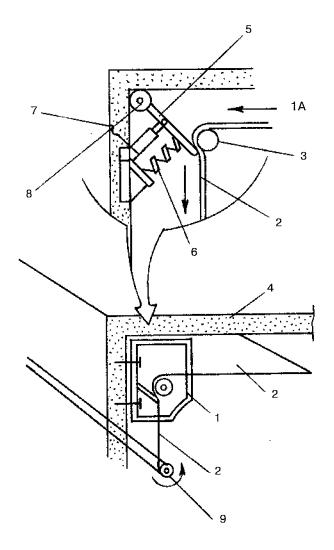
Закрепление багетов для натяжного потолка: 1 — корпус рейки крепления; 2 — пластиковая пленка; 3 — валик; 4 — потолочное перекрытие; 5 — рычаг; 6 — пружина рычага; 7 — выключатель; 8 — ось рычага; 9 — валик, необходимый для натяжения пленки
